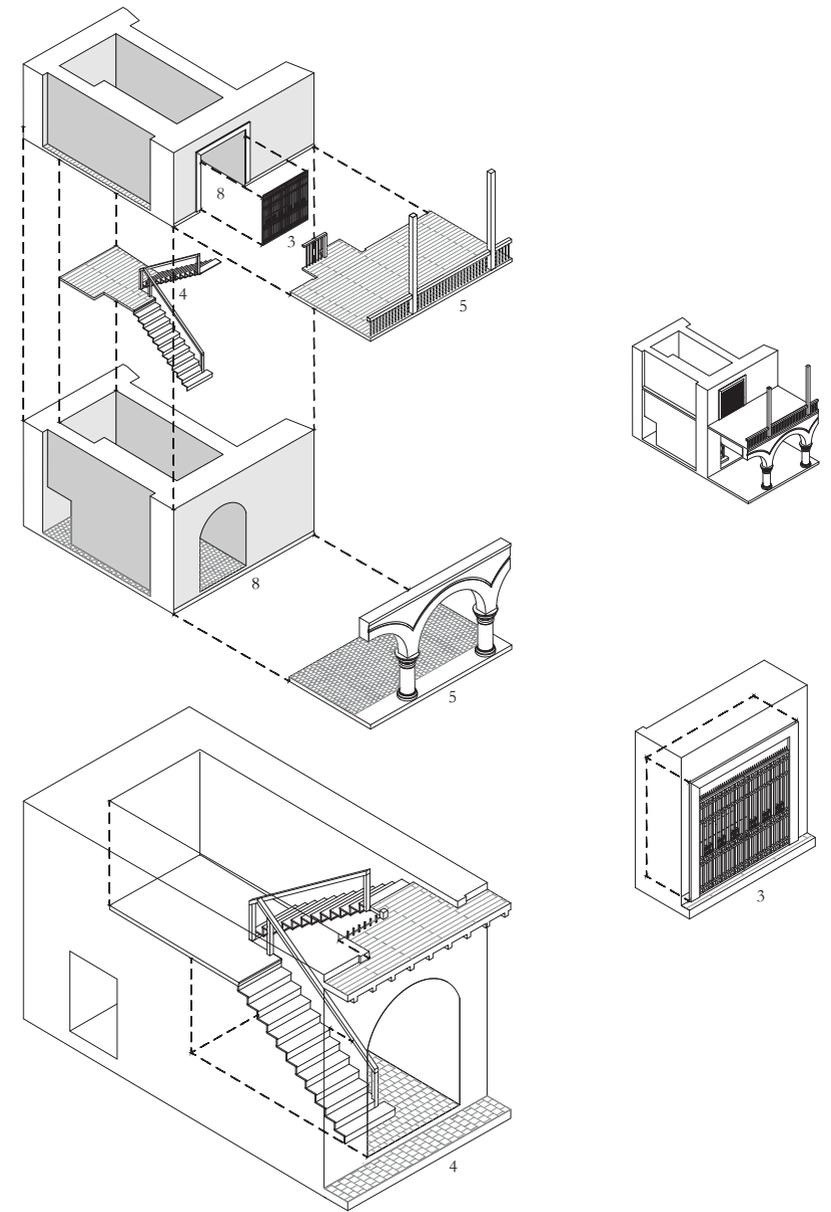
Plano ubicación Control de Niveles Divergentes. (2020). Planimetría. Elaboración propia.
